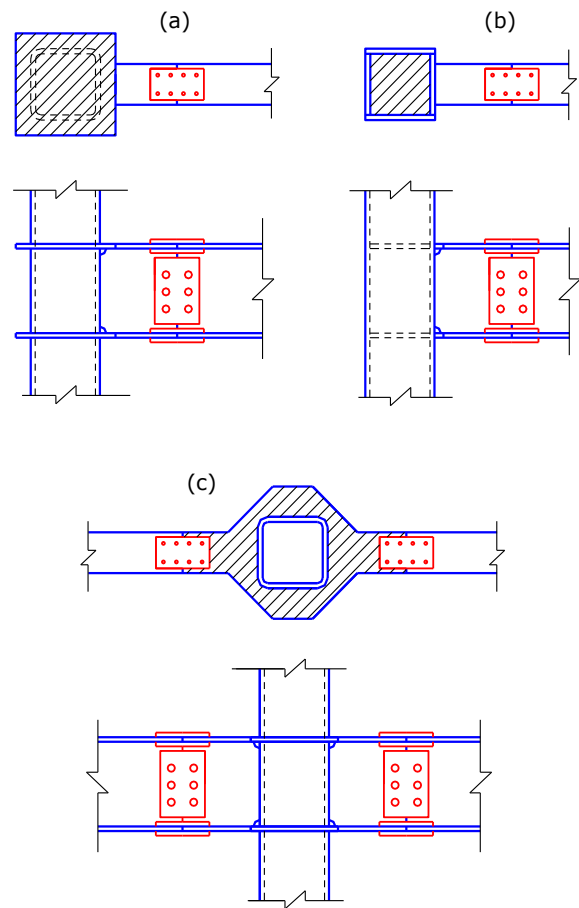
Conexiones usadas en Japón para columnas tubulares o de sección cajón, (a) con placa a través de la columna, (b) con placa interior, y (c) con placa alrededor del nudo ([Bruneau et al., 2011](#)).
